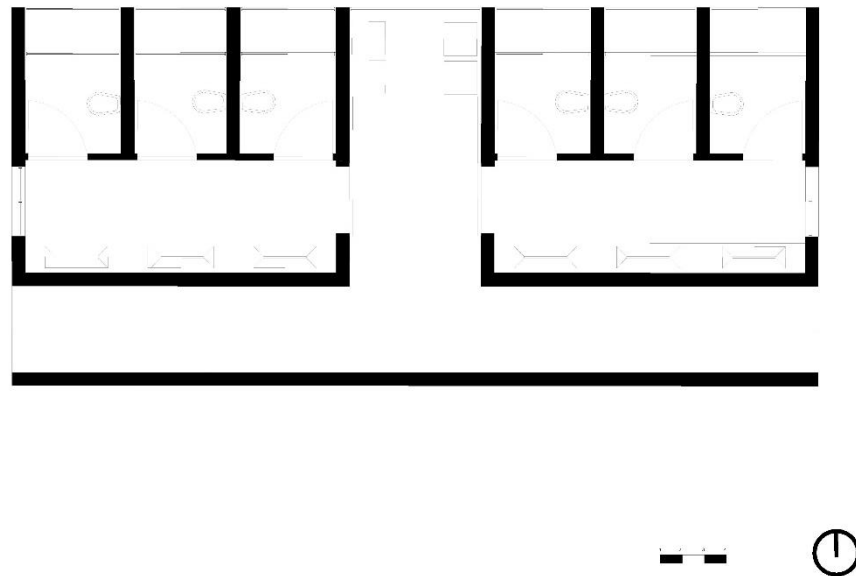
Planta referente às Instalações Sanitárias
